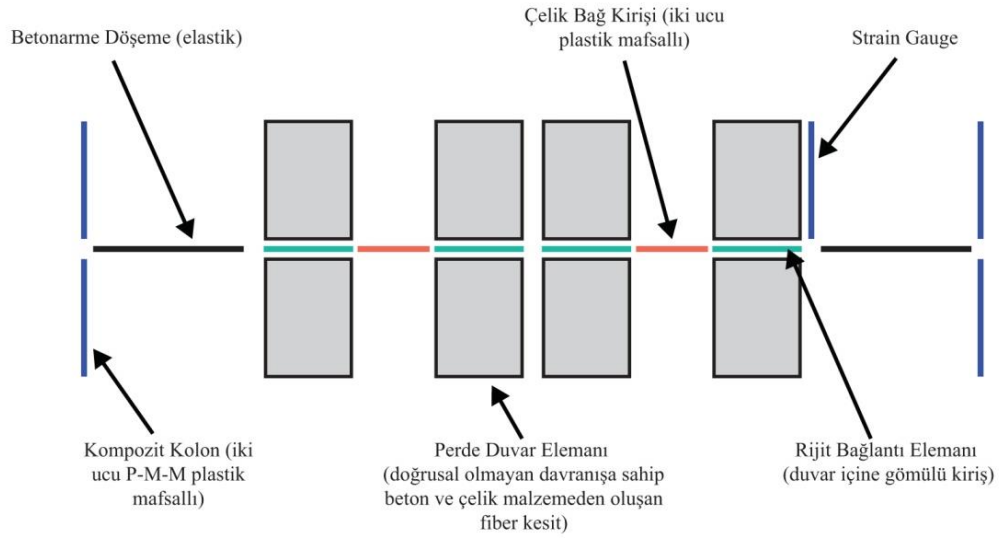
Modellenen yapının taşıyıcı sistem kalıp planı.
